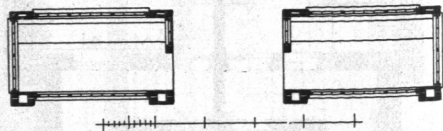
Wartehalle an dem Landungssteg Lombardsbrücke, Grundriß.
